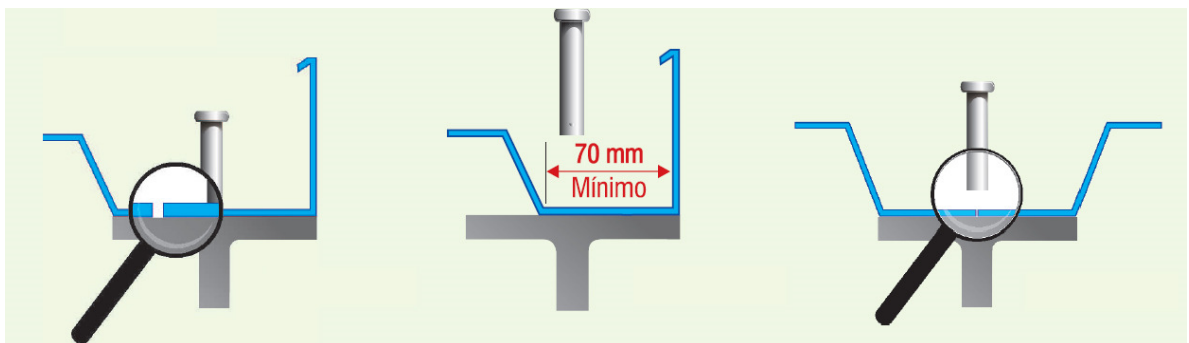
Instalação de pinos em vigas com steel deck (Ciser, 2001).
